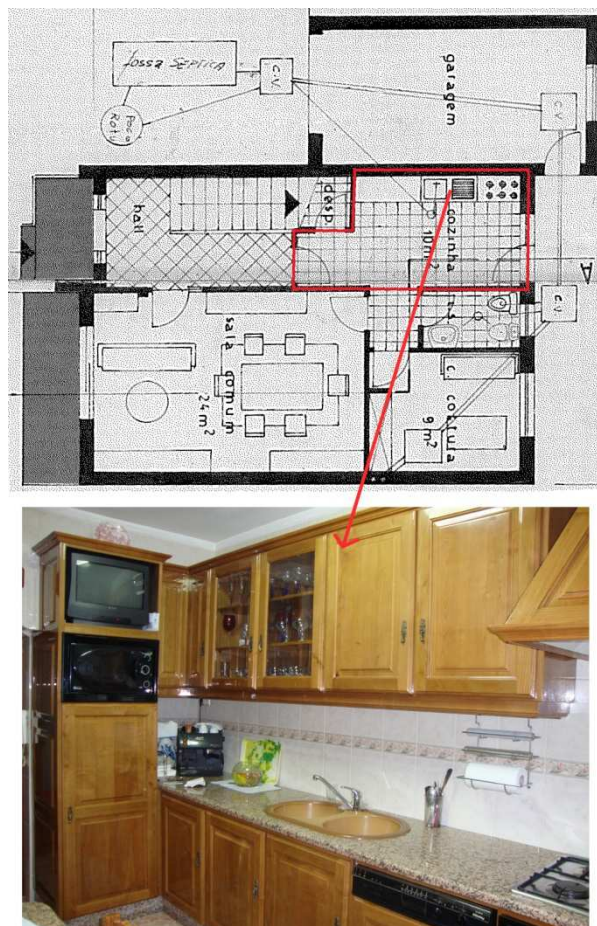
Planta do r/chão e identificação do elemento fonte de manutenção em estudo
